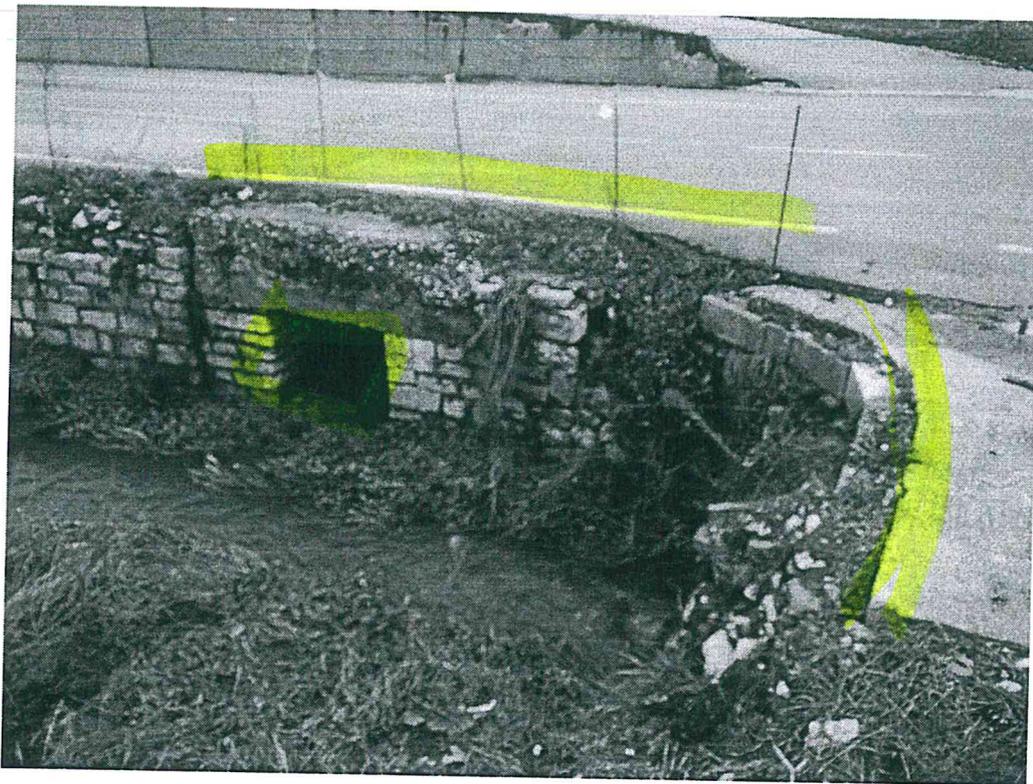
C.da Piane sbocco attraversamento + crollo muro contenimento
